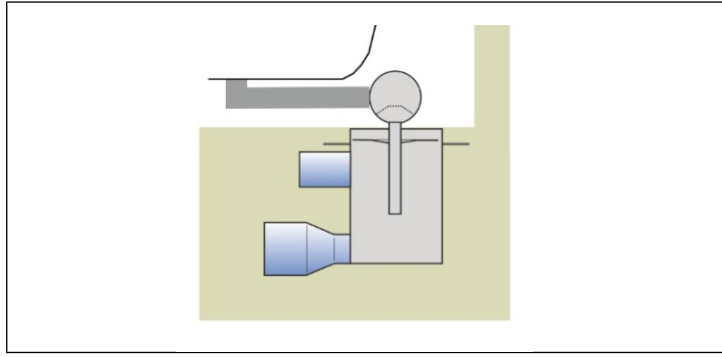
Installation ReQup®-Floor adaptation sous baignoire
